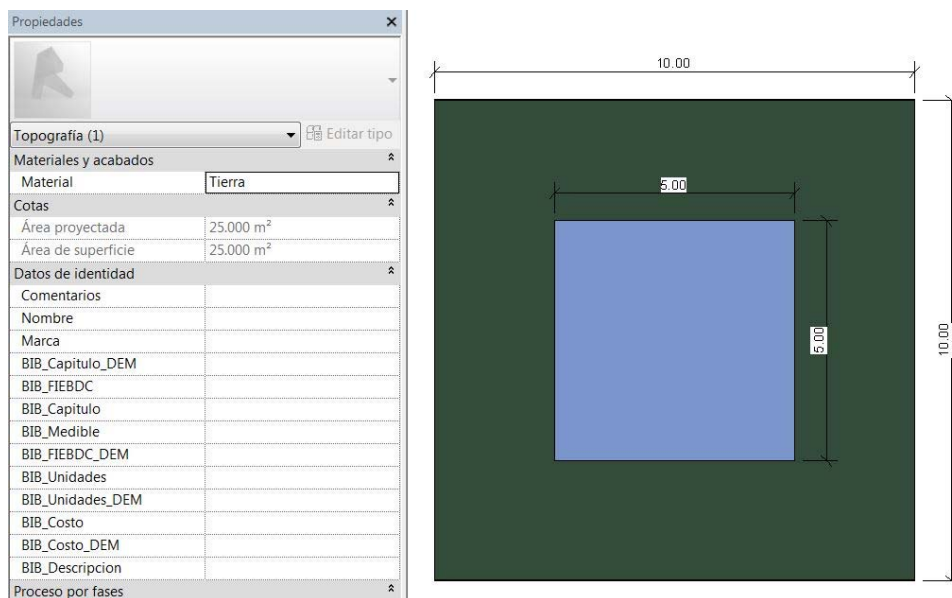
Vista en planta subregión y propiedades de ejemplar
